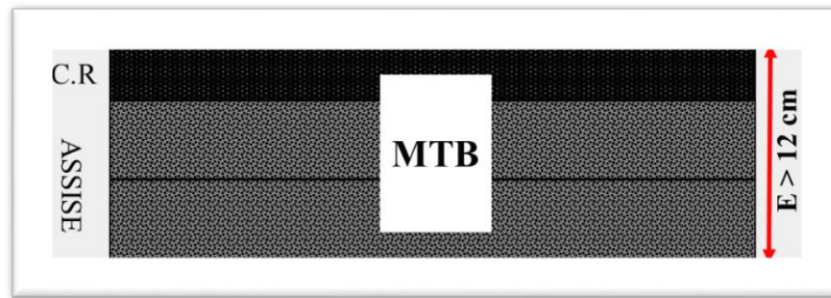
schématisation d'une chaussée bitumineuse épaisse
